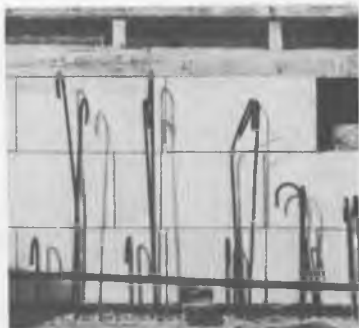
Применение ячеистобетонных блоков в качестве несъемной опалубки при бетонировании монолитной стены
